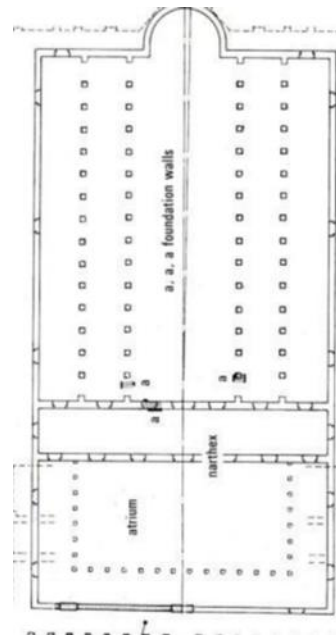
Abb. XXX: Frühchristliche Basilika Grundriss
